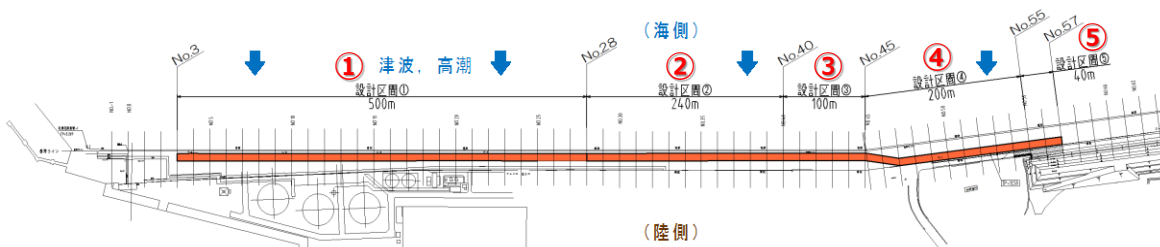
対象施設の全体平面図（総延長 1,080m，設計区間①～⑤）
